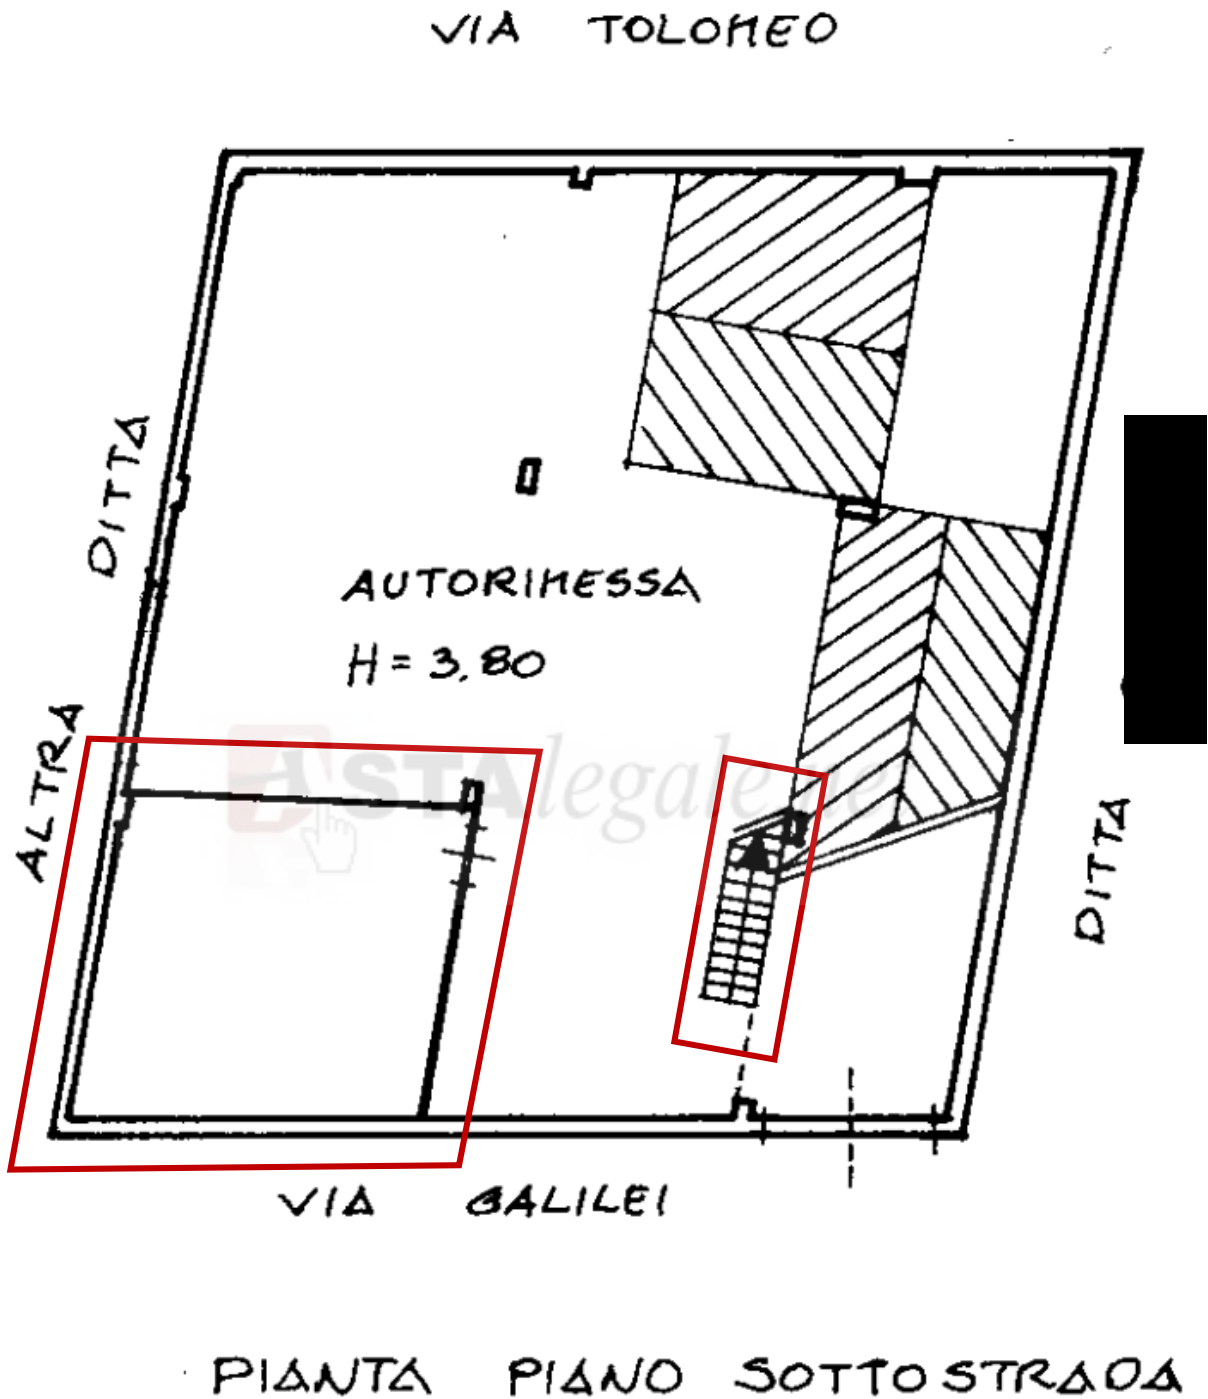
Planimetria Catastale PIANO SOTTOSTRADA - Foglio n°76, Particella n°1598, Sub 2
